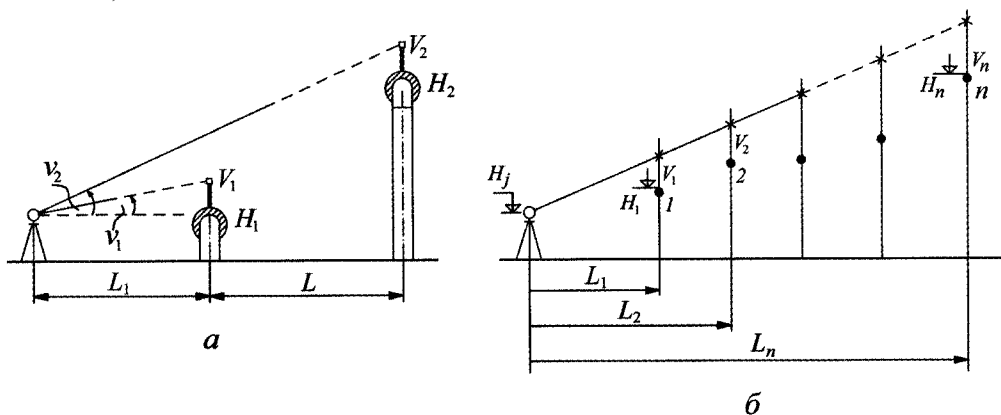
Способи нівелювання нахилених конструкцій:
